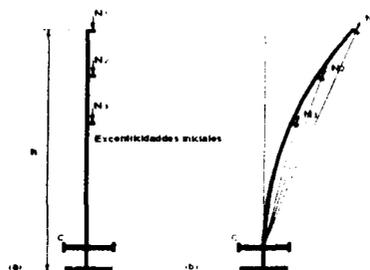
4 Flexión del pilón en la dirección perpendicular al plano del puente
